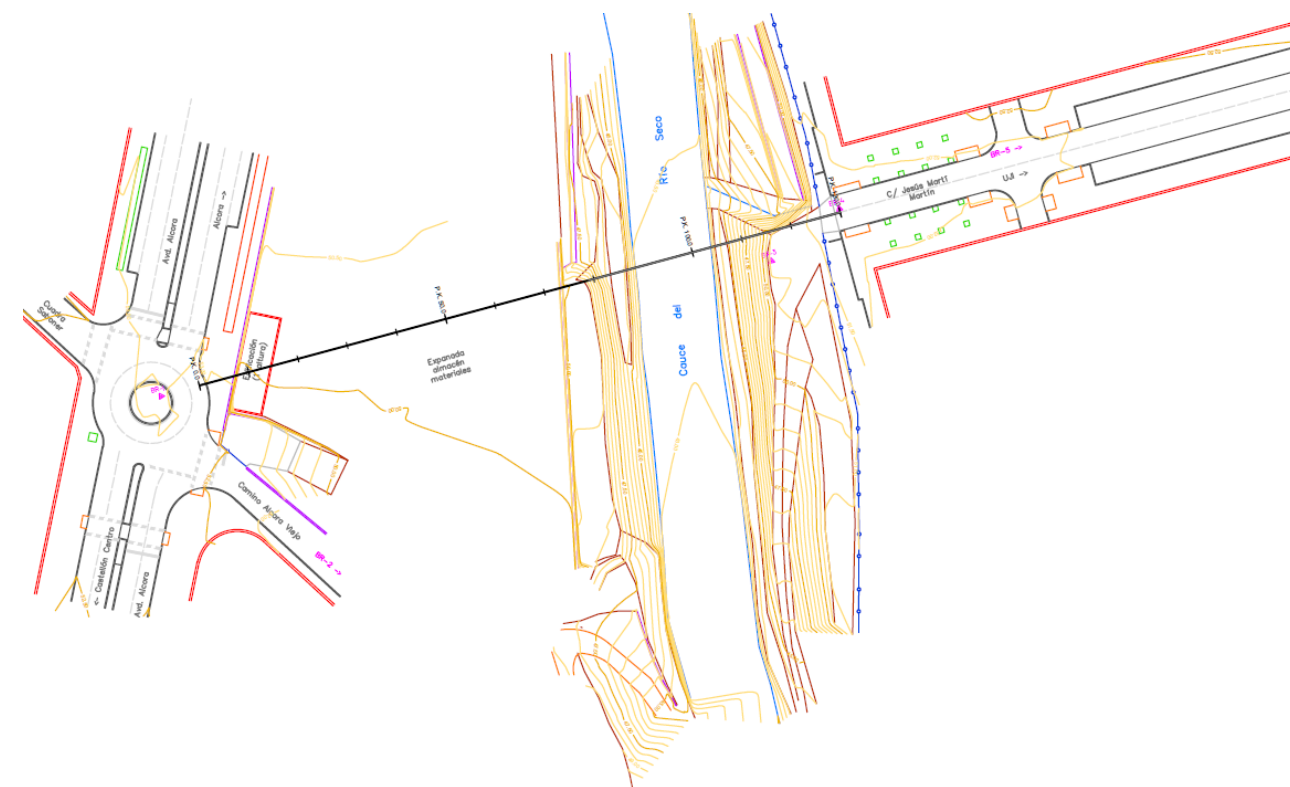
Trazado en planta del tramo de calle a ejecutar (figura extraída del Plano nº3: Planta general de actuaciones).
